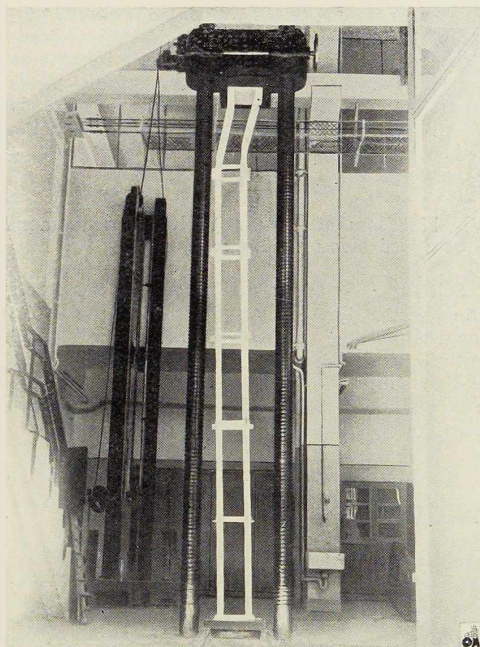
Machine d'essai pour pièces soumises au flambement.
